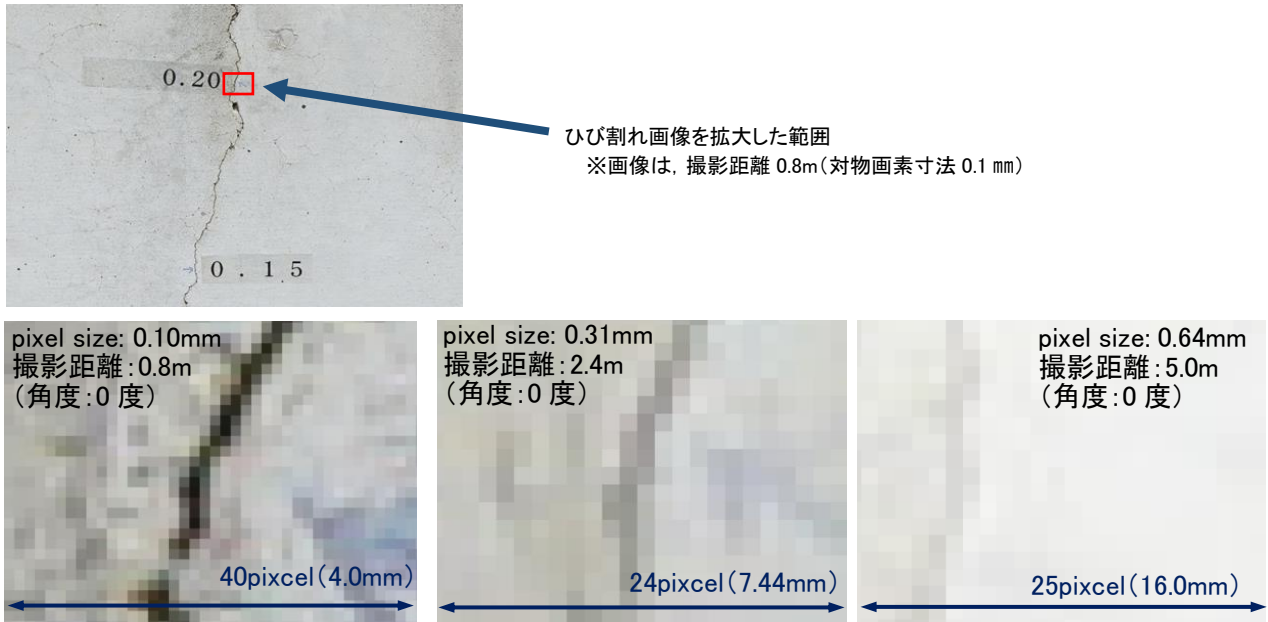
距離の違いによるひび割れの見え方の違い
